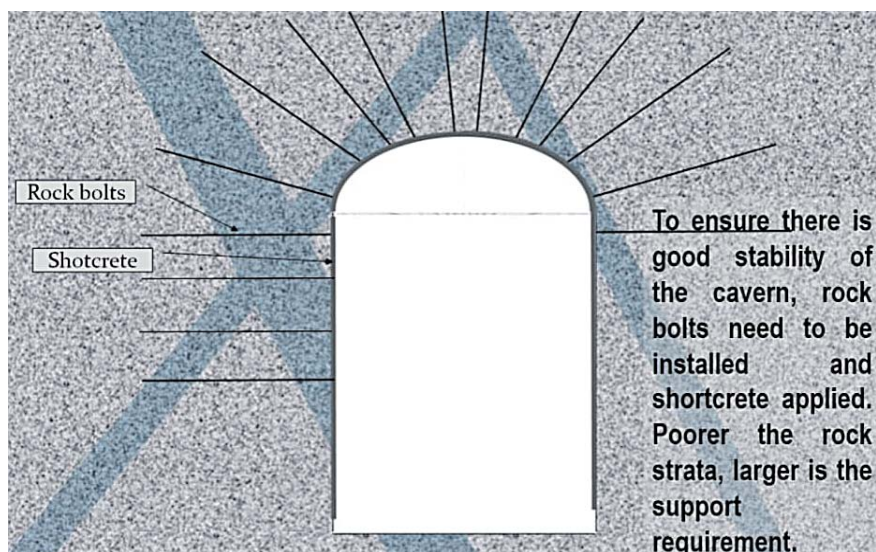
Крепление подземной полости металлическими стержнями и набрызгбетоном (голубые слои — нарушенные зоны).
